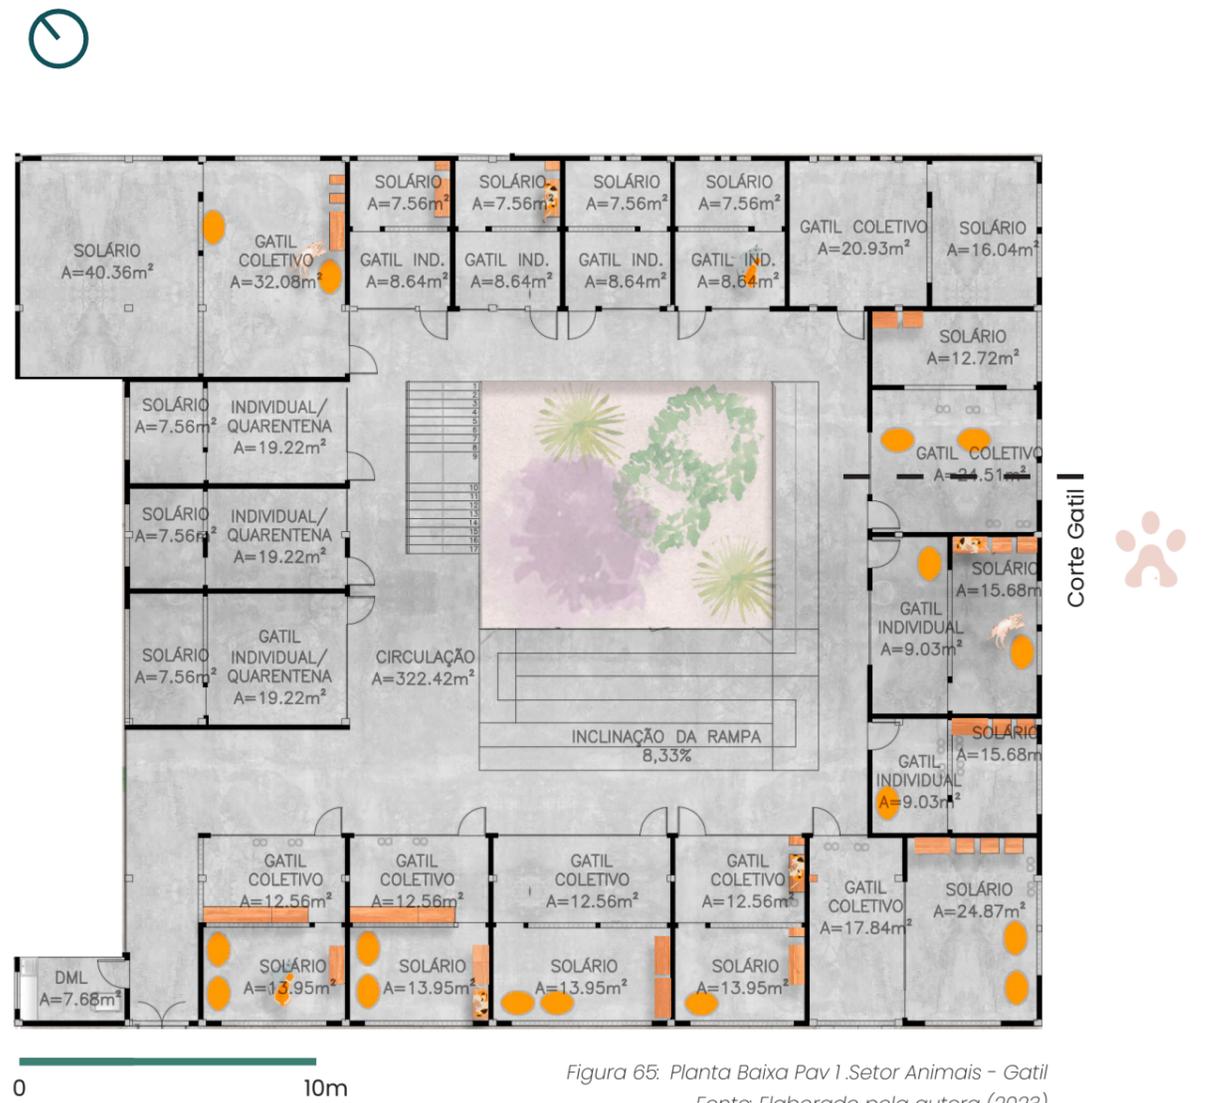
Planta Baixa Pav. 1. Setor Animais - Gatil
